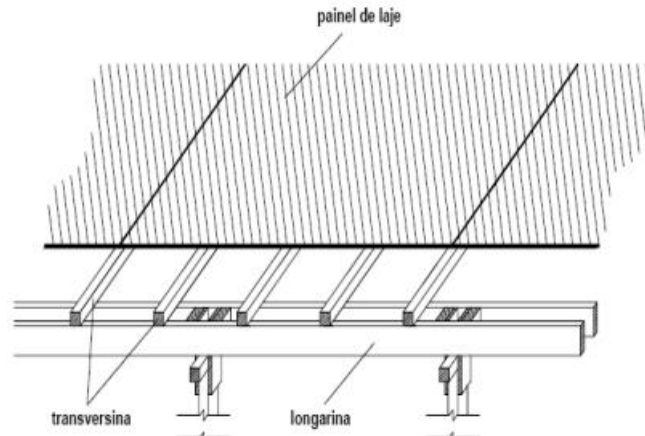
Exemplo de composição de cofragem e escoramento de uma laje
